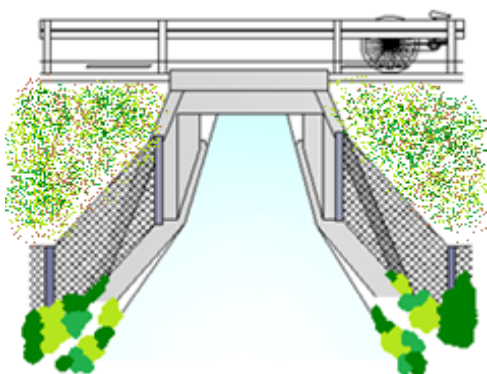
Drenaje adaptado para animales terrestres. Fuente: propia.
